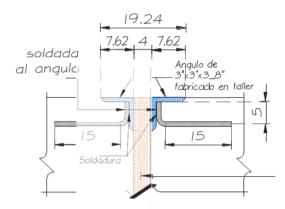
Junta de poliestireno, para su colocación en los accesos del puente.
